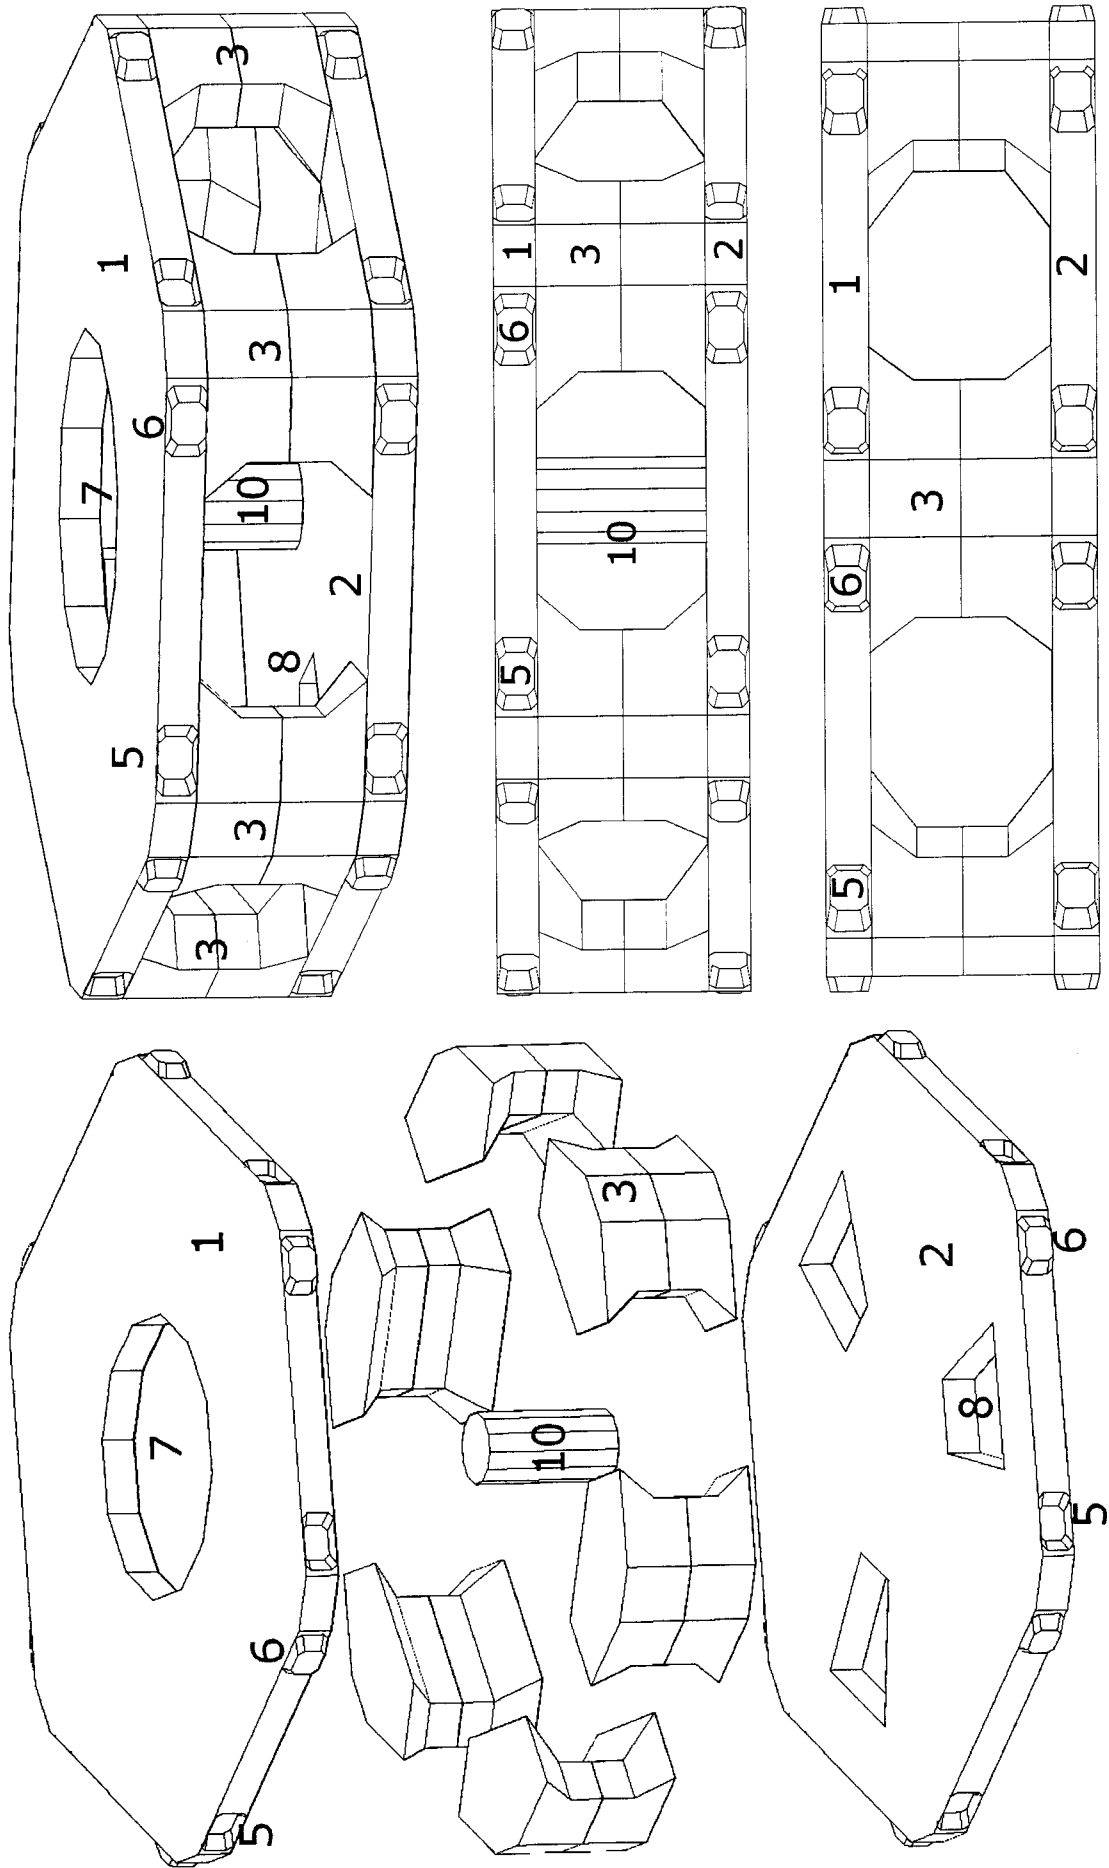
Estructura Resistente - Versión COLUMNAS INDEPENDIENTES: Despiece y Vistas 3D , Perfil y Planta
